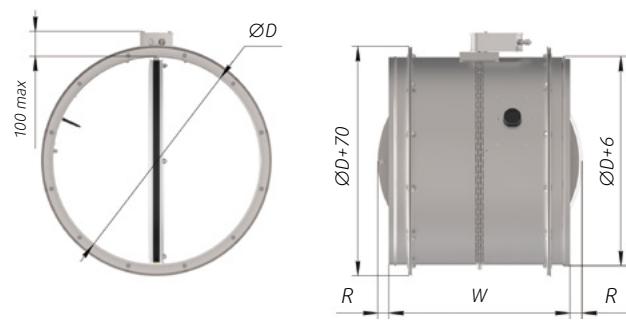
б-2 Размеры ниппельного клапана HELMER 630-1000 мм, EI90
